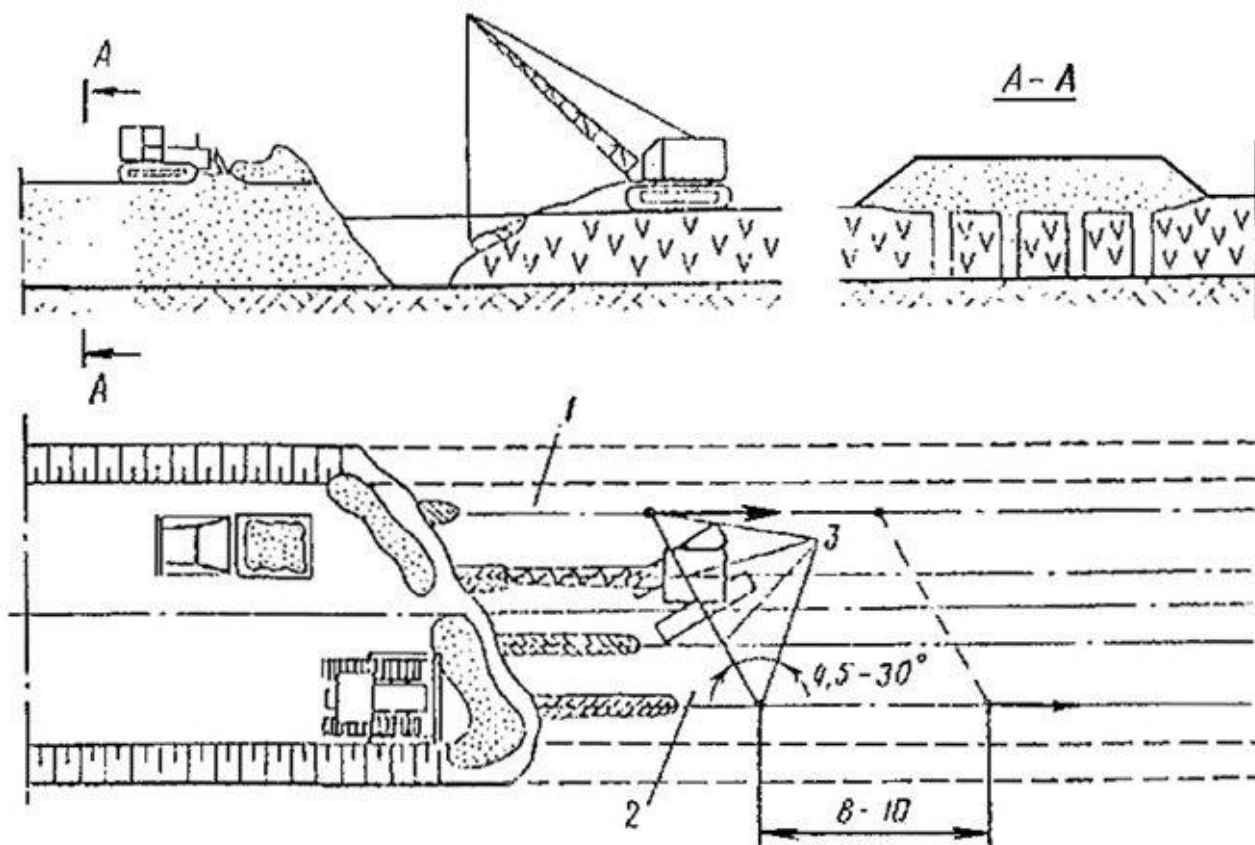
Схема посадки насыпи на дно болота методом перегрузки:
